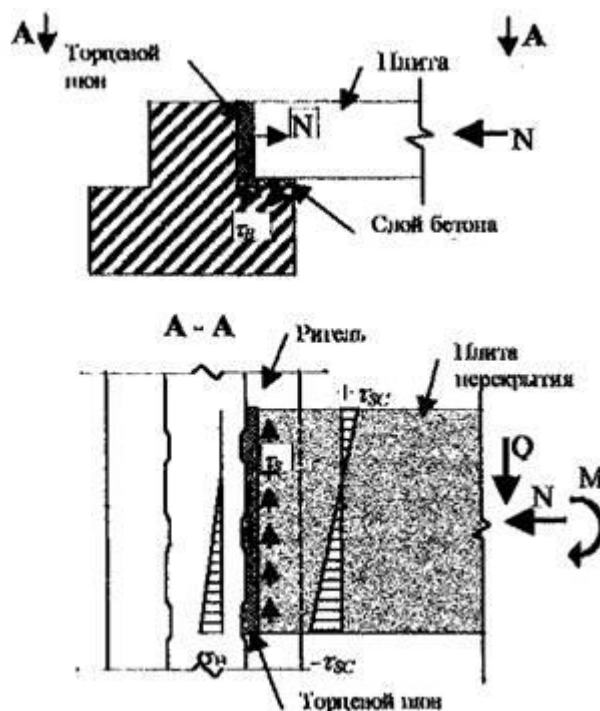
Схема взаимодействия многоярусной плиты с ригелем: $\tau_{\text{ш}}$ - касательные напряжения в торцевом шве при сдвиге плиты вдоль ригеля; $\tau_{\text{с}}$ - касательные напряжения по площадке опирания плиты на ригель при сдвиге и повороте плиты относительно ригеля; $\sigma_{\text{в}}$ - сжимающие напряжения в торцевом шве
